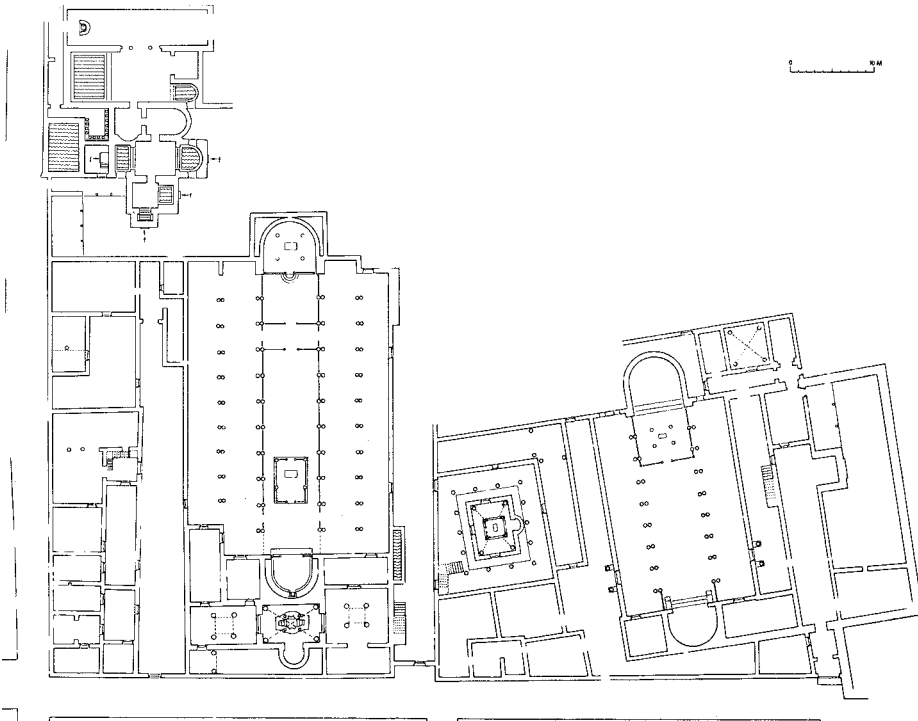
Grundriß des Kathedralenkomplexes (nach: Duval – Baratte 1973, 34 Abb. 18)
